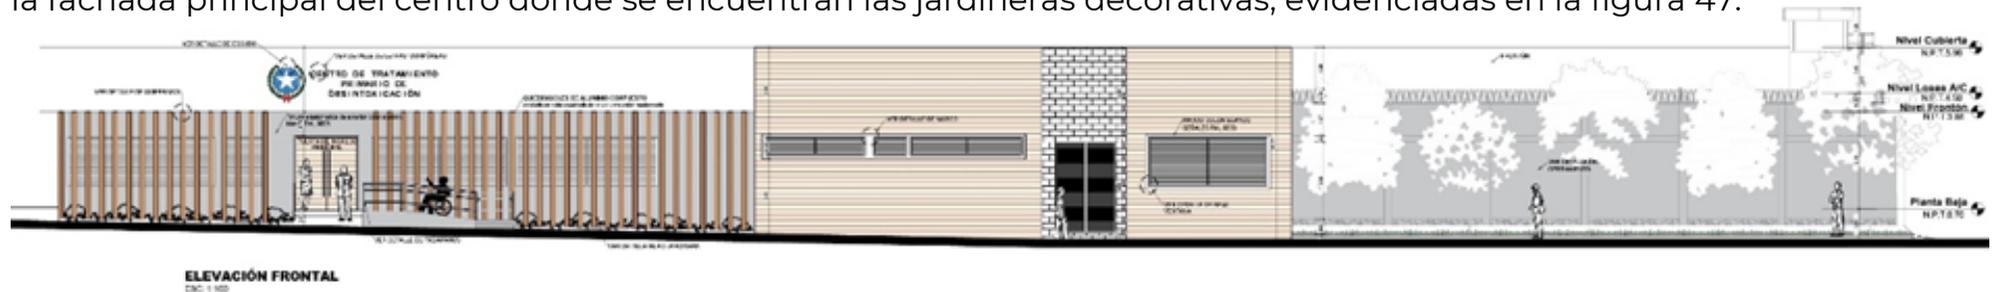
Fachada frontal del centro de desintoxicación para mujeres.
